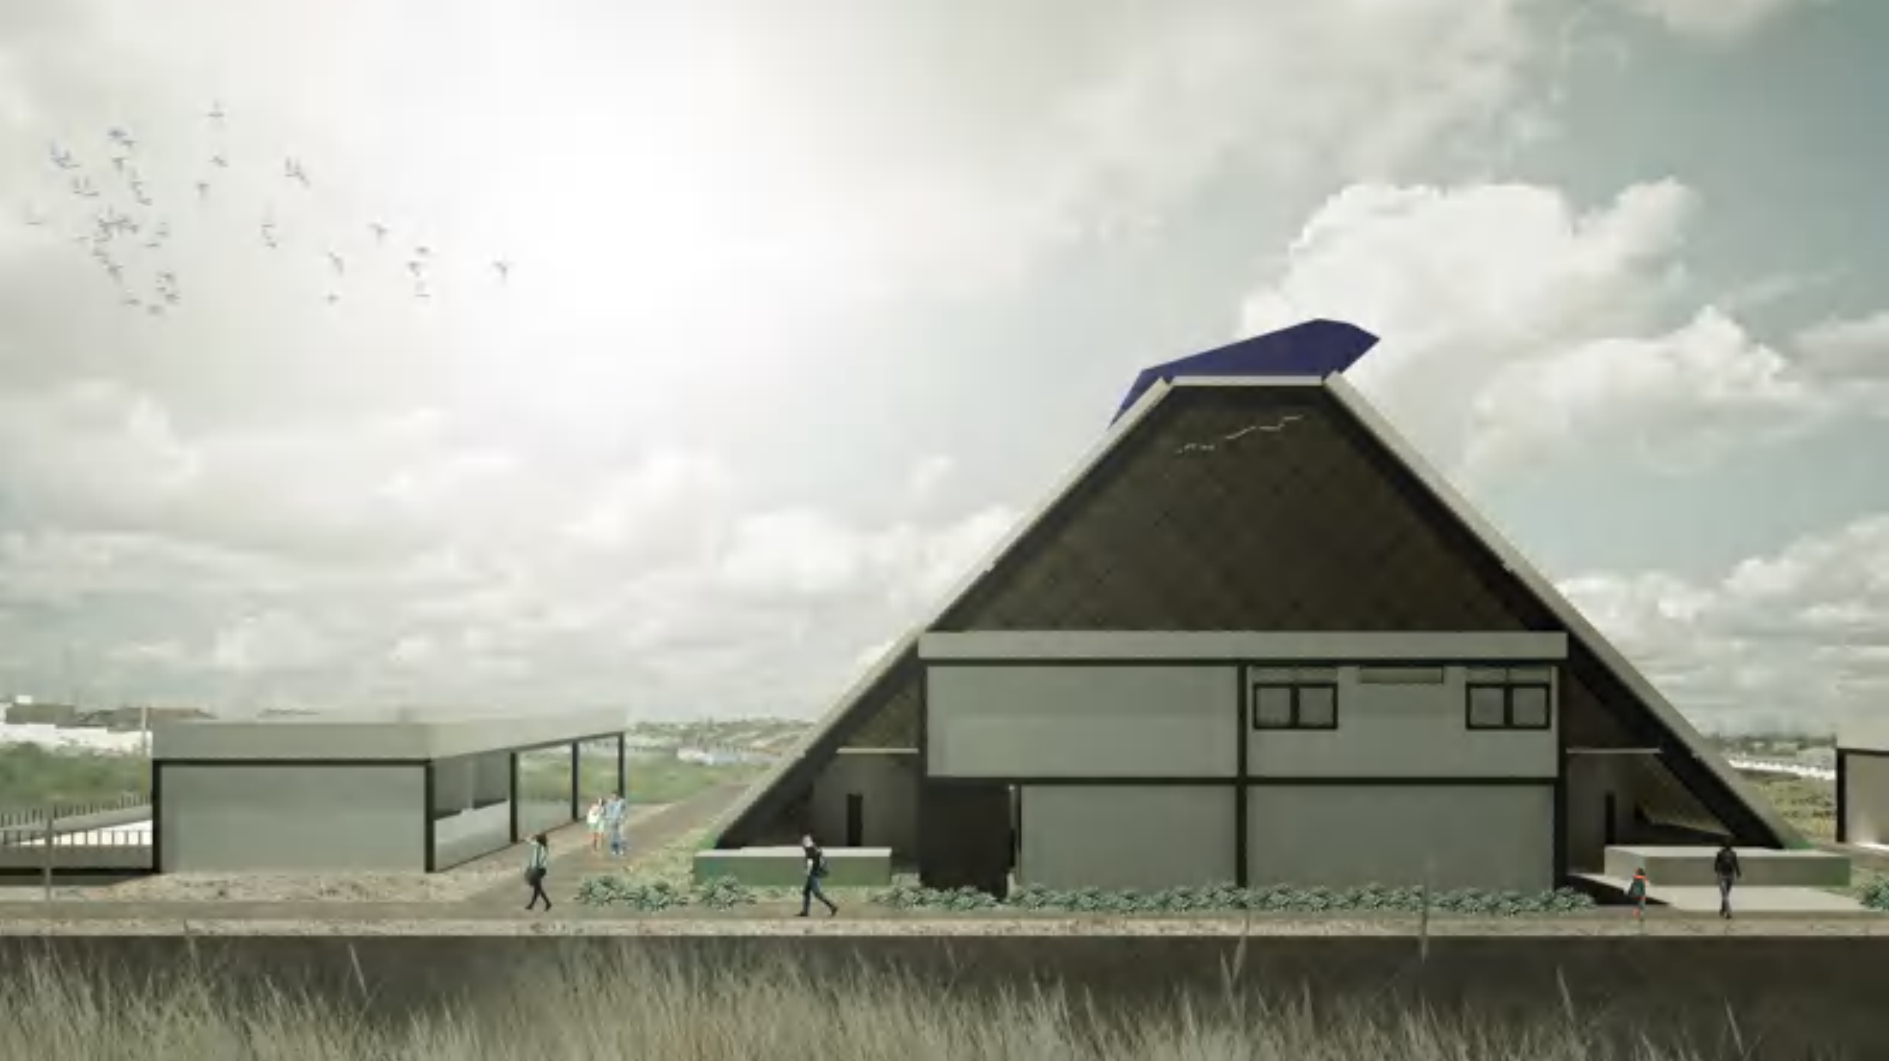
Fachada Posterior Bloco Ginásio e Bloco Apoio e Serviço
